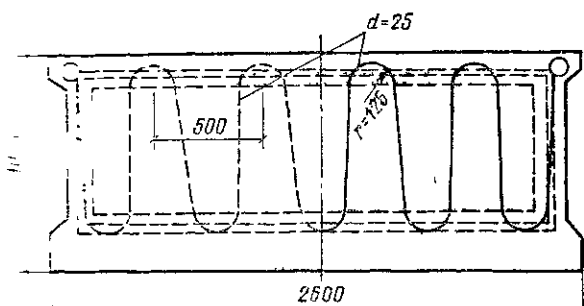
Размещение нагревательного элемента в бетонной лестничной площадке
